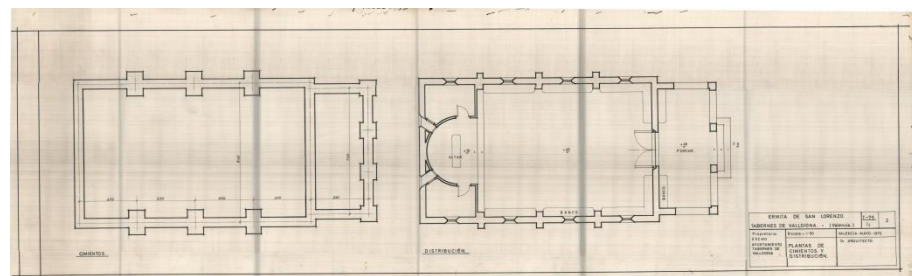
Lámina que incluye la planta de cimentación y de distribución de un segundo proyecto de la Ermita
